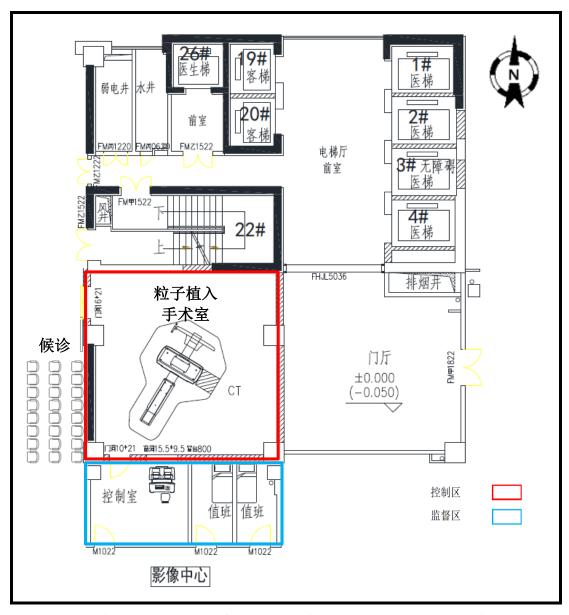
本次竣工环保验收项目粒籽植入手术室等场所(住院楼一楼)平面布置示意图
